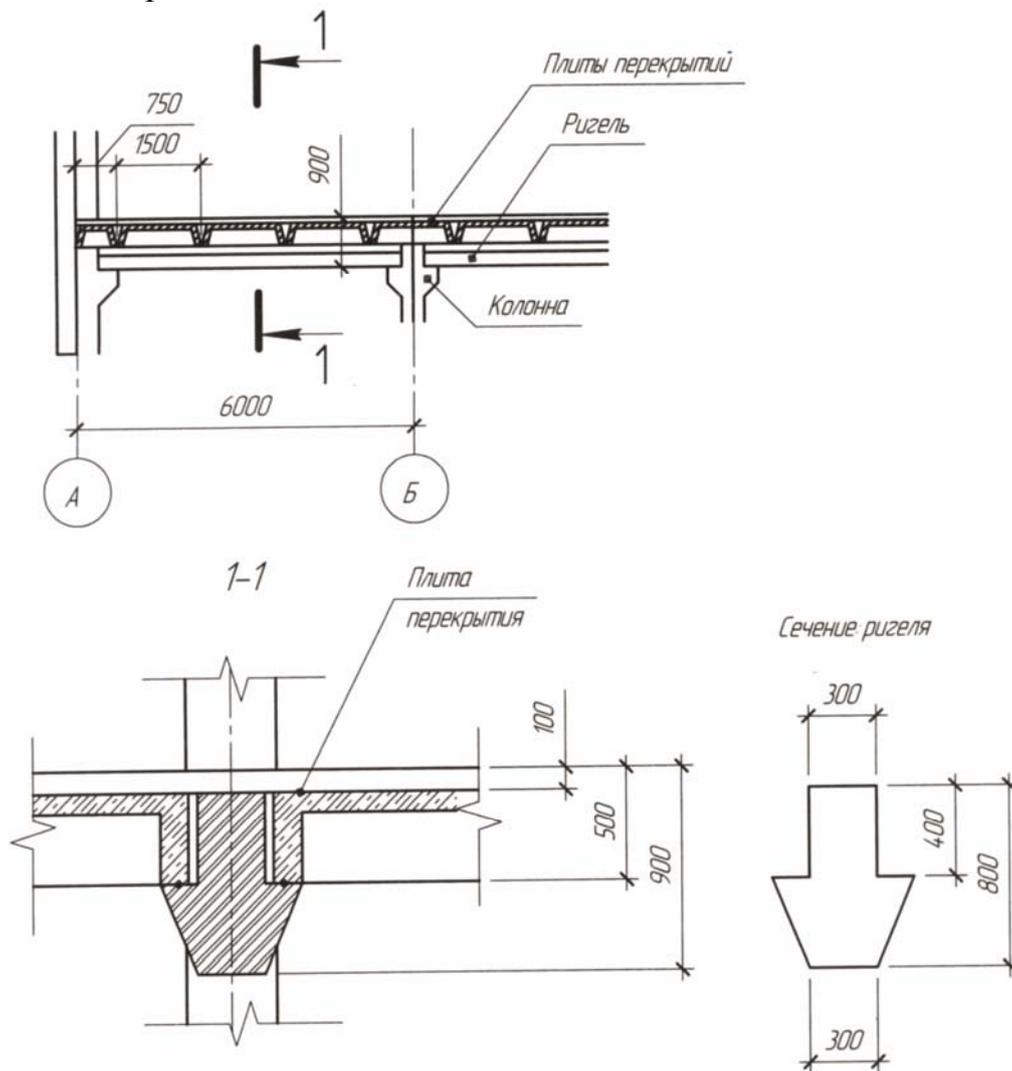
Конструкция междуэтажного перекрытия двухэтажных зданий
